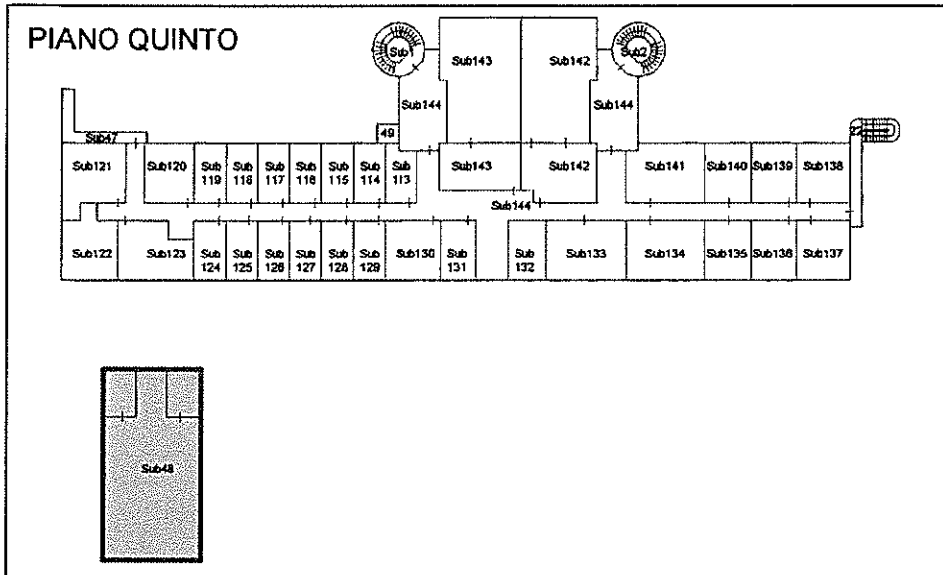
Elaborato planimetrico piano 5. Individuazione sub 48 (porzione).
